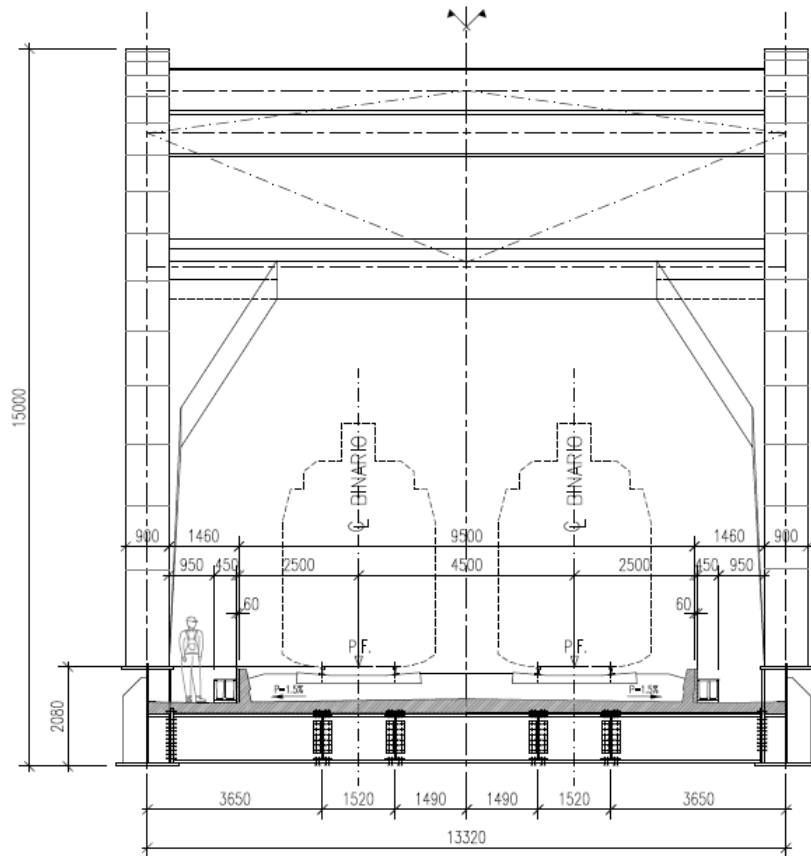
Sezione trasversale tipo dell'impalcato metallico.
